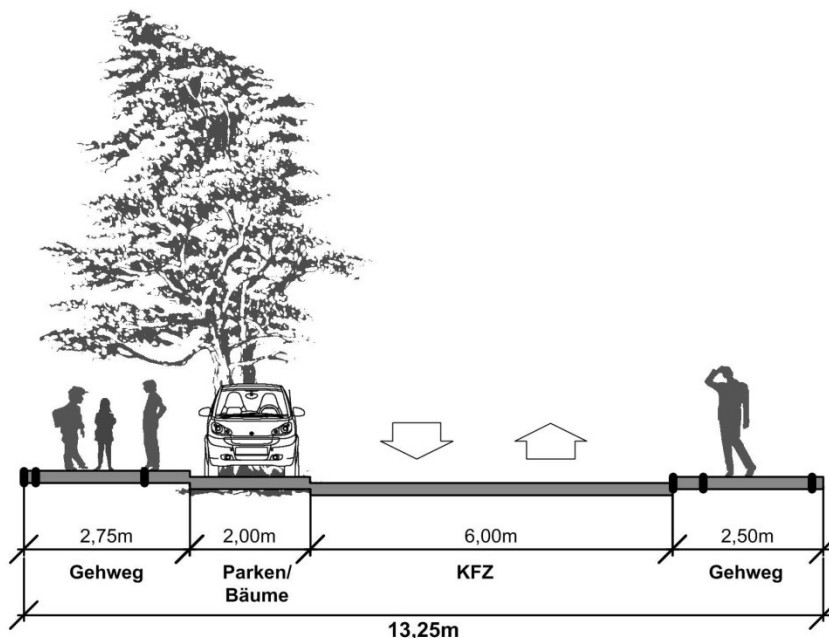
Straßenquer. Planstraße A, Quelle raith hertelt fuß
